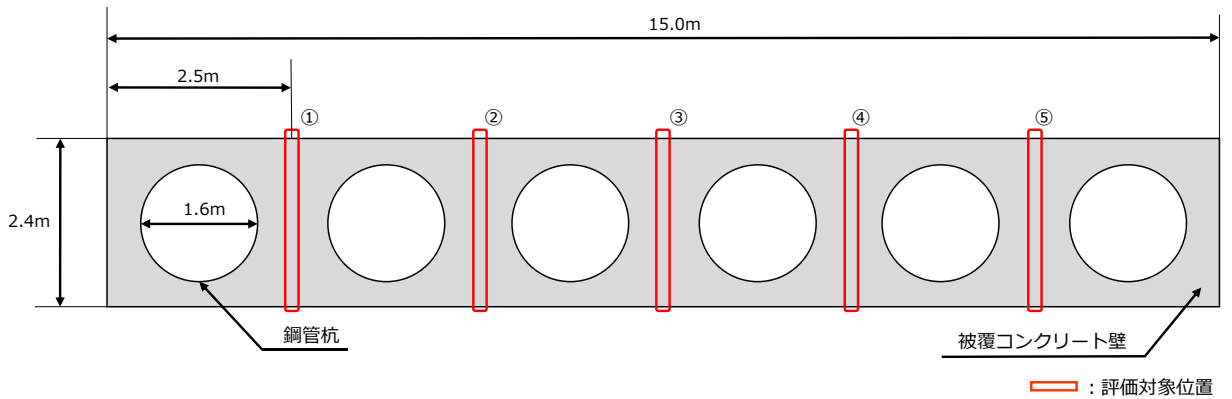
(1) 評価対象位置図 (②-②断面 平面図)
